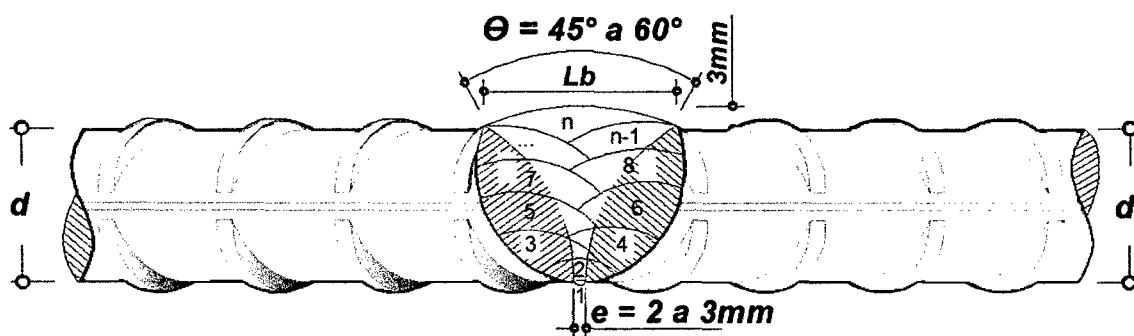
Soldadura con borde o bisel en “V” y el número de pasadas “n”.
